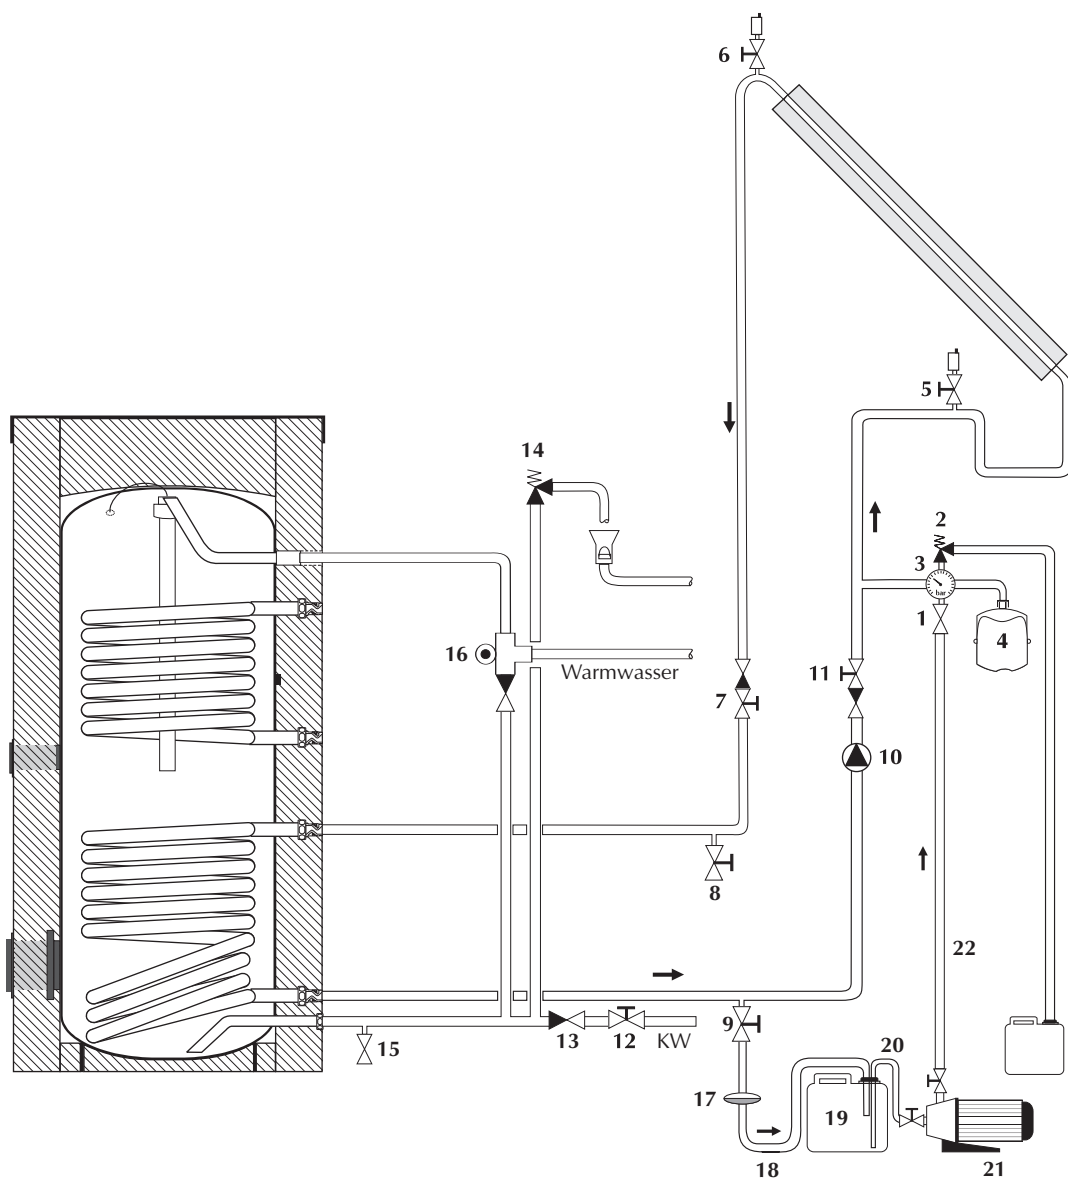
Befüllpumpe KS mit Saug-, Entleerungs- und Druckschlauch sowie eingebautem Filter
